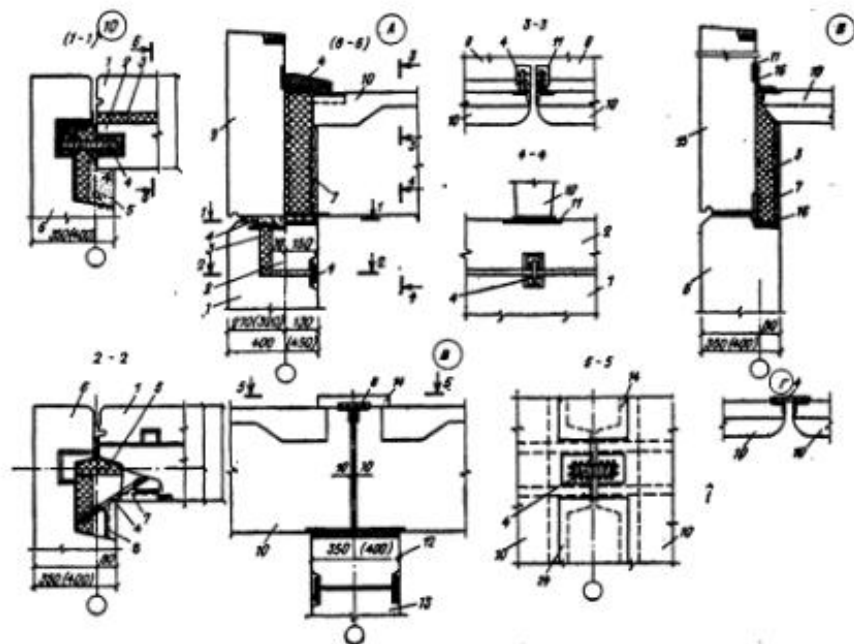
Узлы 10 - 14 сопряжения несущих конструкций залых помещений: 1 — панель продольной несущей наружной стены; 2 — железобетонная балка-лежень; 3 — утеплитель; 4 — соединительный элемент; 5 — бетон замоноличивания; 6 — панель торцевой наружной стены; 7 — штукатурка по сетке; 8 — петлевой арматурный выпуск; 9 — парапетная панель; 10 — панель покрытия типа «ТТ»; 11 — закладная деталь; 12 — железобетонный лежень; 13 — панель внутренней несущей стены; 14 — железобетонная доска; 15 — парапетная панель торцевой стены; 16 — соединительный уголок
